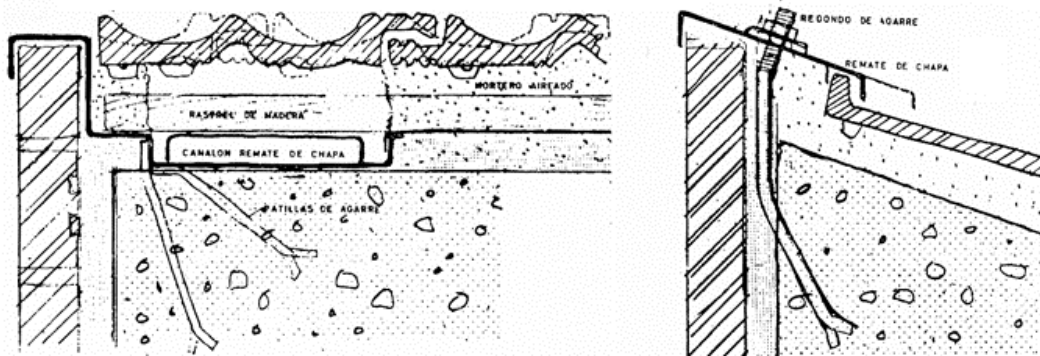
Detalles de encuentro de plano de cubierta y de fachada. Izquierda: sección transversal por el volumen de la biblioteca. Derecha: sección transversal del remate en el volumen de estares
